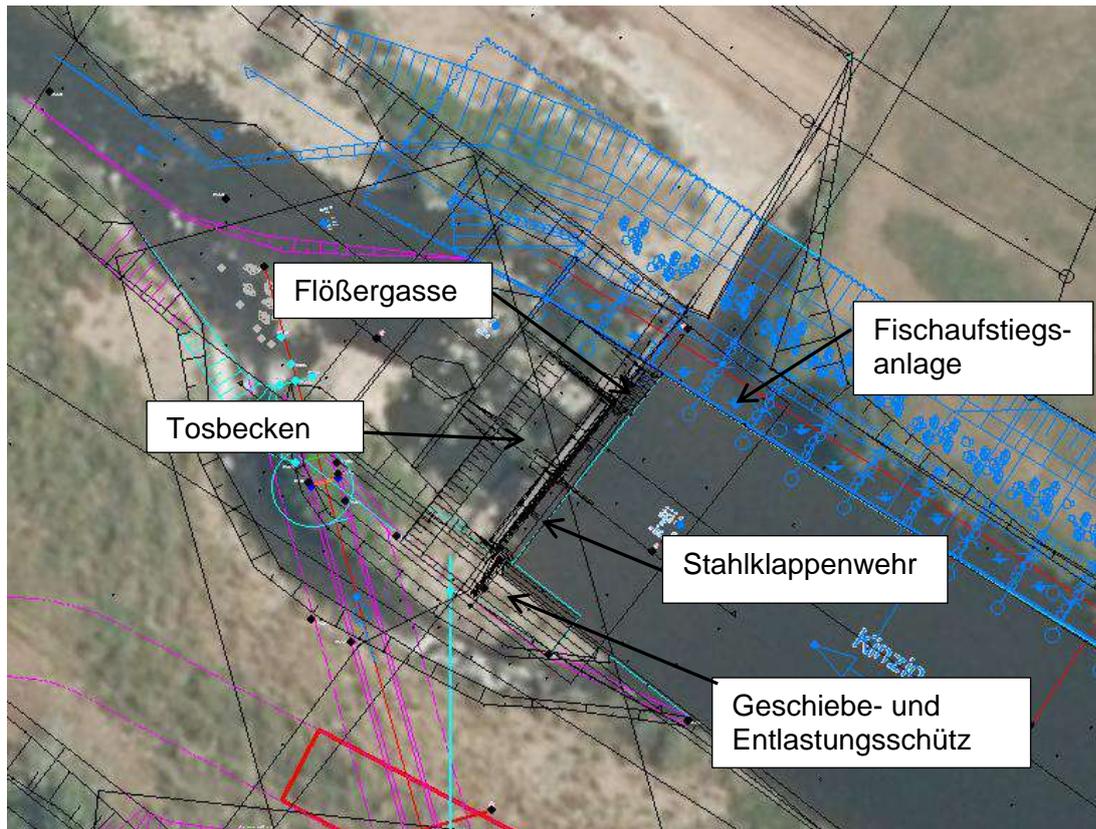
Ausschnitt Lageplan und Planung FAA (Hydro Energie Roth 2021)
